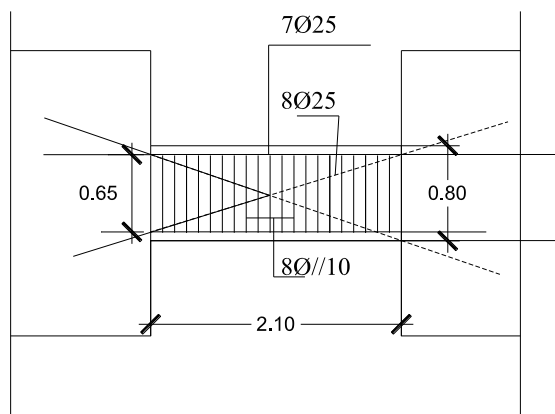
Pormenorização da armadura exemplo de VAY (1)
